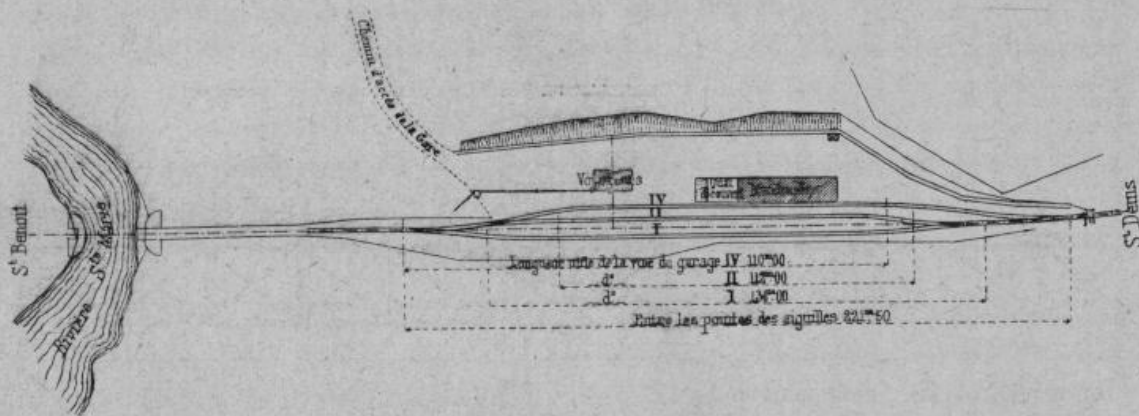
PLAN DE LA GARE SAINTE-MARIE.
